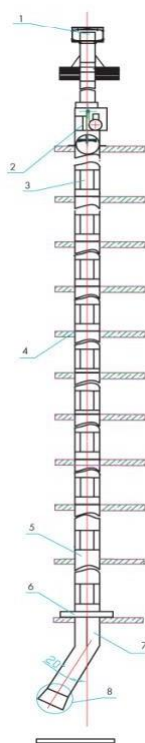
Схема мусоропровода: 1) вентиляционный узел; 2) очистное моюще-дезинфицирующее устройство; 3) загрузочный клапан; 4) хомут опорно-разгрузочный; 5) ствол; 6) опора ствола; 7) патрубок шибера; 8) шибер
